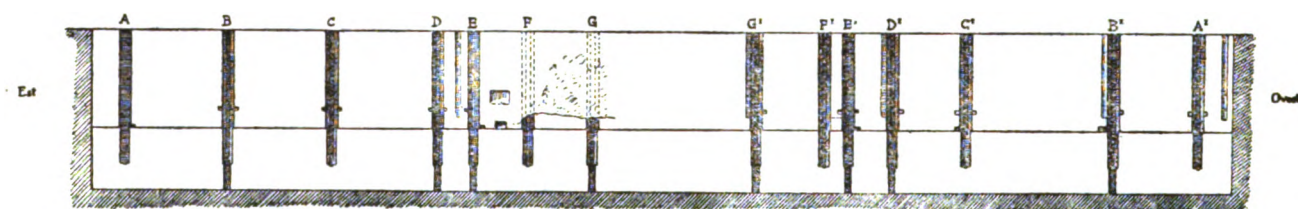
IL CANALE DELLO AULÉO (PROSPETTO DELLA PARETE DI FRONTE AL KOILON).
